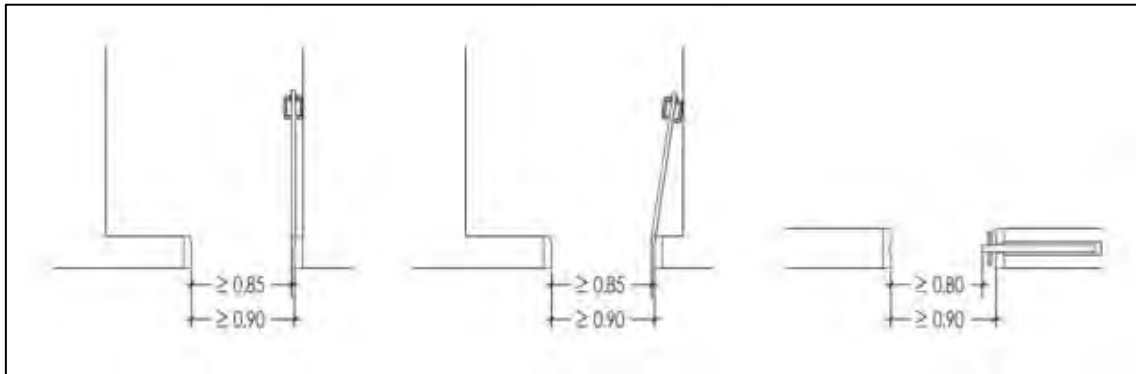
Croquis anchos de elementos accesibles. Decreto 65/2019.
